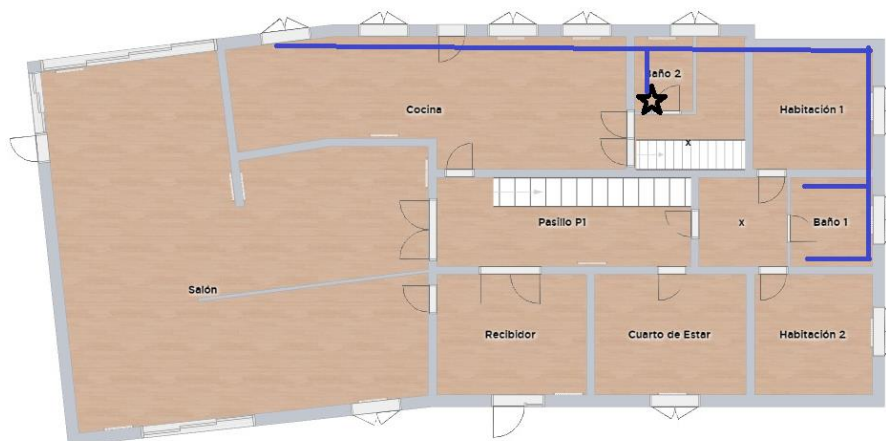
Tuberías de agua caliente sanitaria por la primera planta. (Fuente: Trabajo de Fin de Grado)
